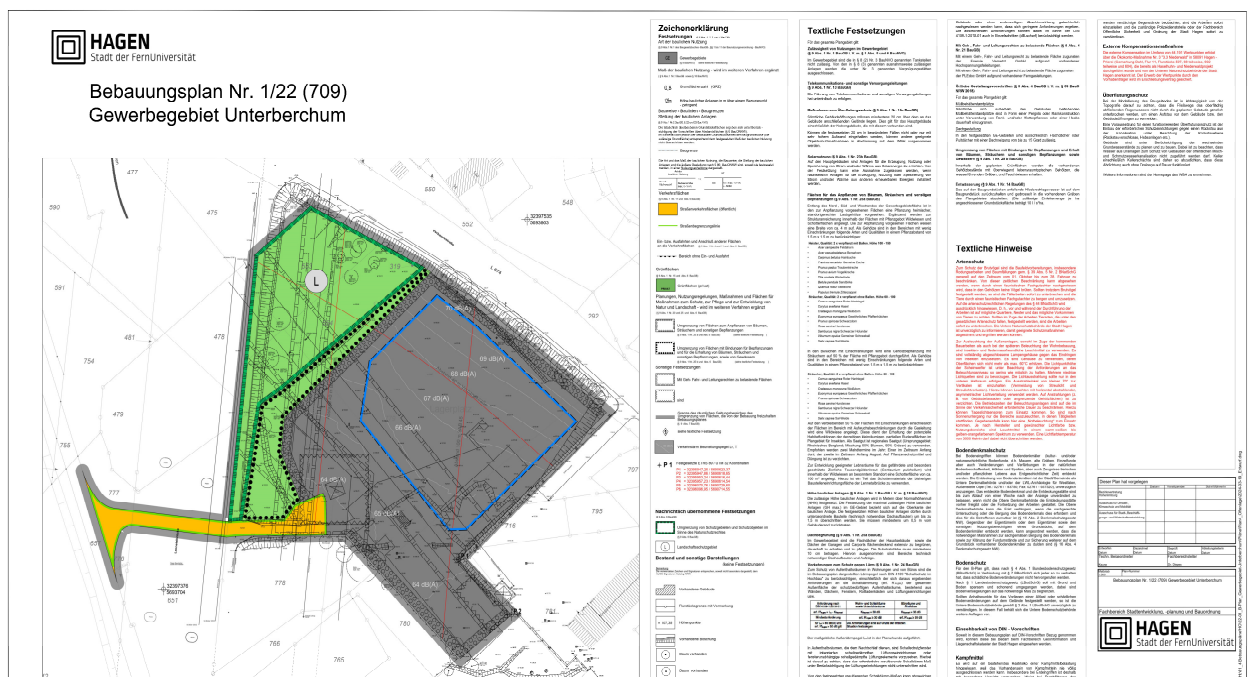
Bebauungsplan Nr. 1/22 (709) (Stand: 22.03.2024)
